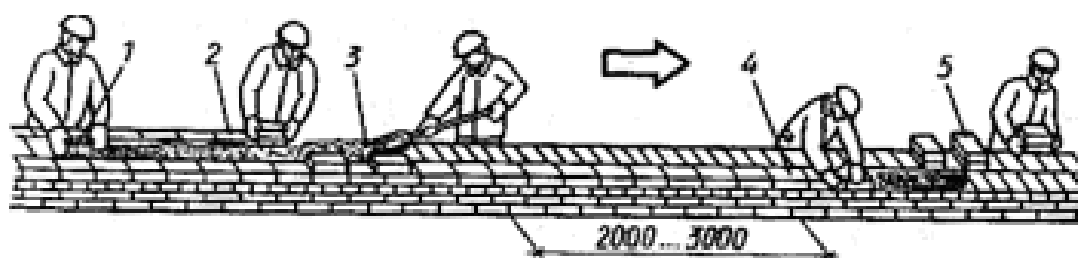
Кладка стены толщины 2 кирпича звеном "четверка", "пятерка" (1- укладка забутки; 2, 4- укладка внутренней и наружной верст; 3- подготовка растворной постели; 5- раскладка кирпича)
